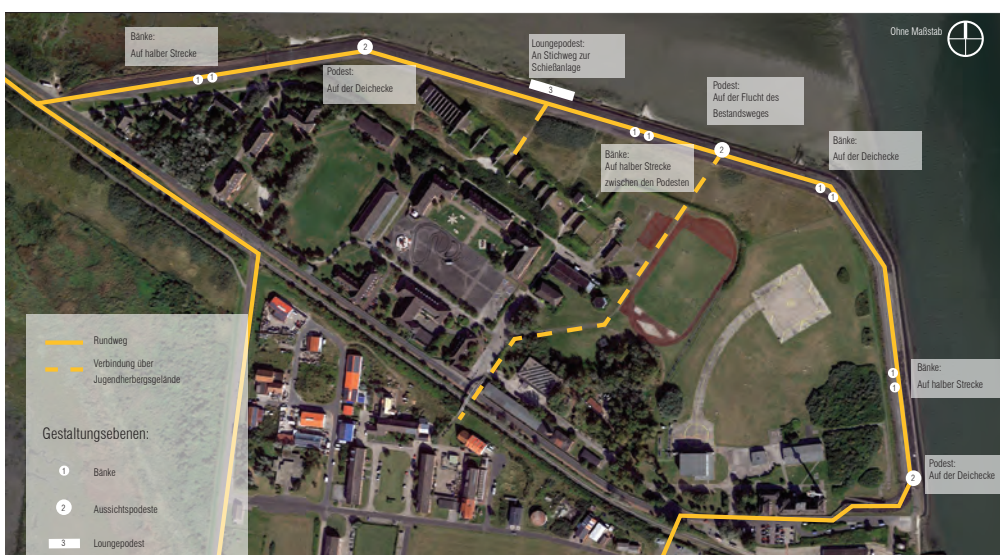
Deichsanierung: Ausstattungsvorschlag und Positionierung Ausstattungselemente (Quelle: Horeis+Blatt)
